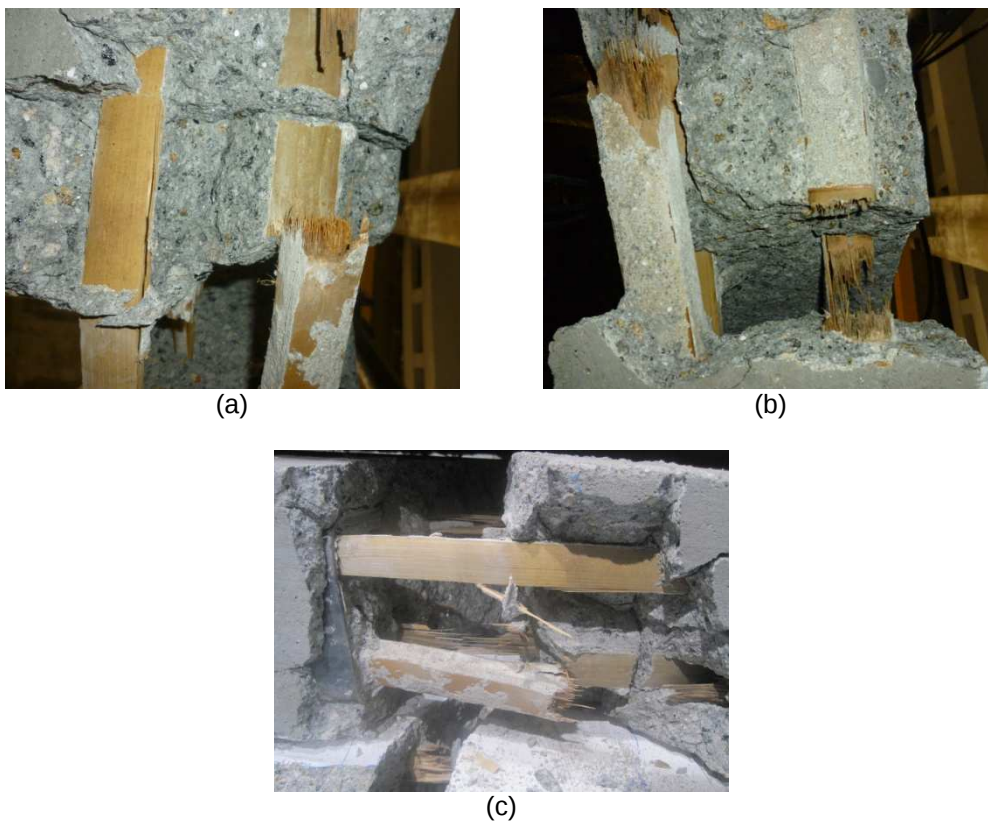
Aderência entre bambu e concreto. (a) Viga V1-2. (b) Viga V2-3. (c) Viga V3-3.
